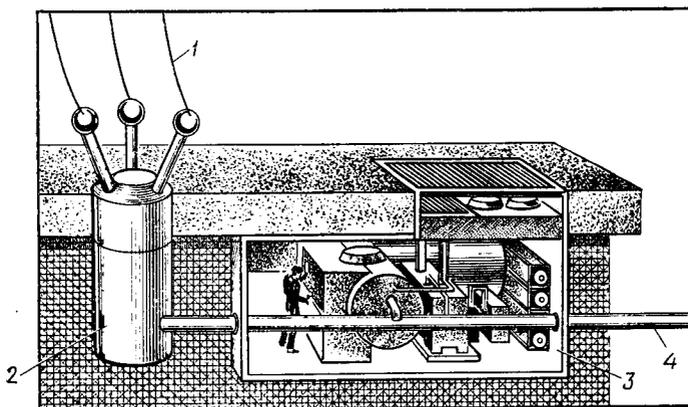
Возможный вариант размещения холодильного оборудования и конструкции кабеля криогенной линии электропередачи:
